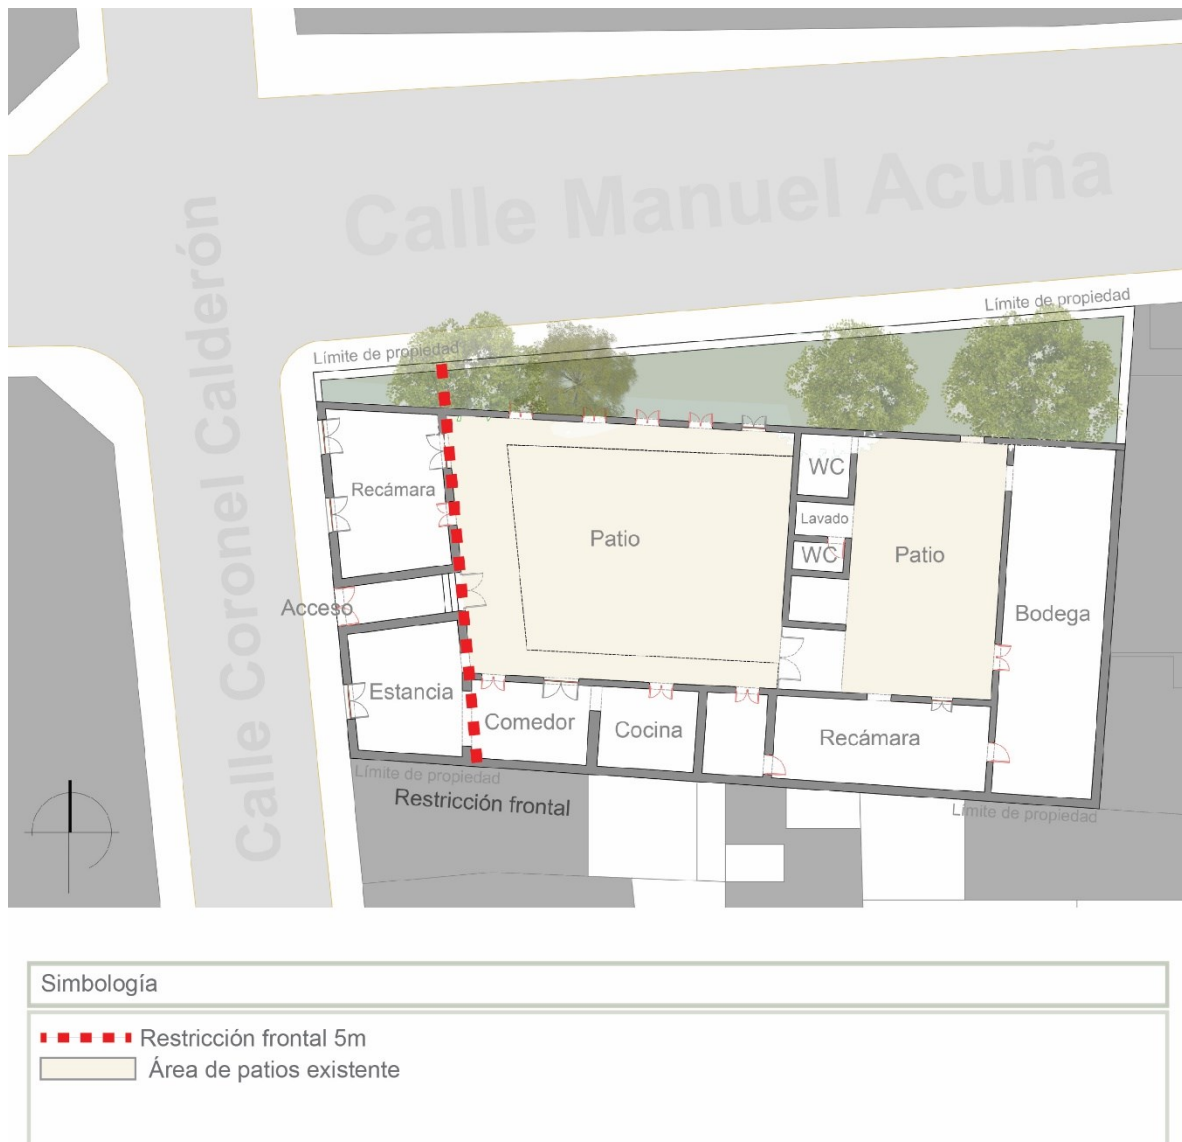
PLANTA BAJA SITUACIÓN ACTUAL. SIN ESCALA.
